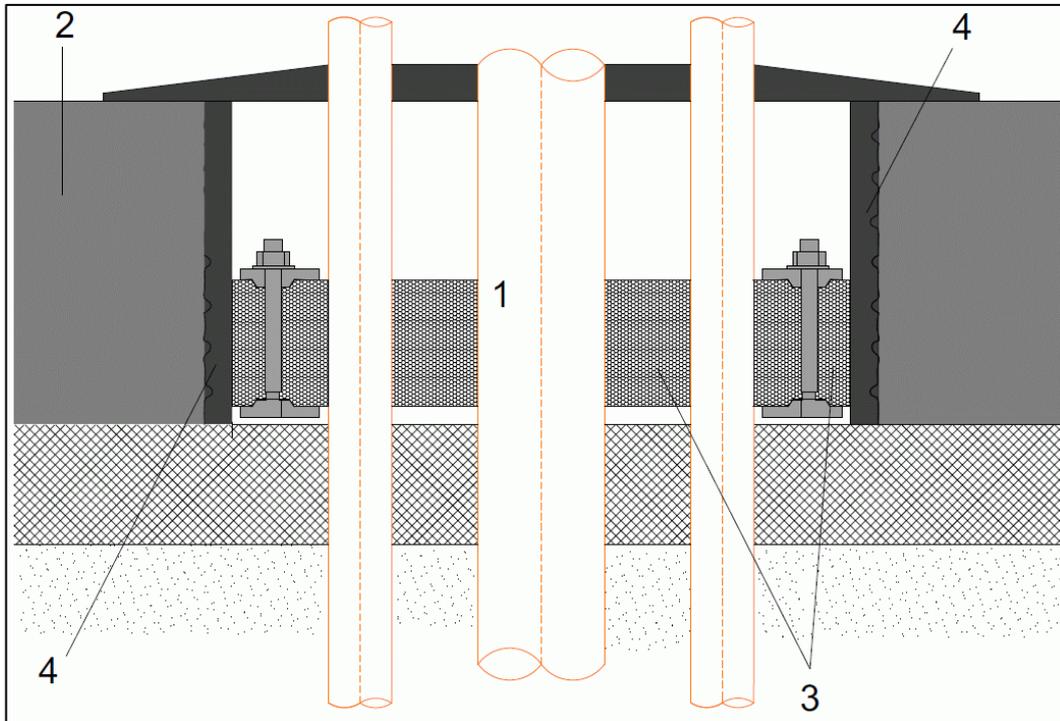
Schnitt durch Mehrsparten Bauteildurchführung in WU-Beton
